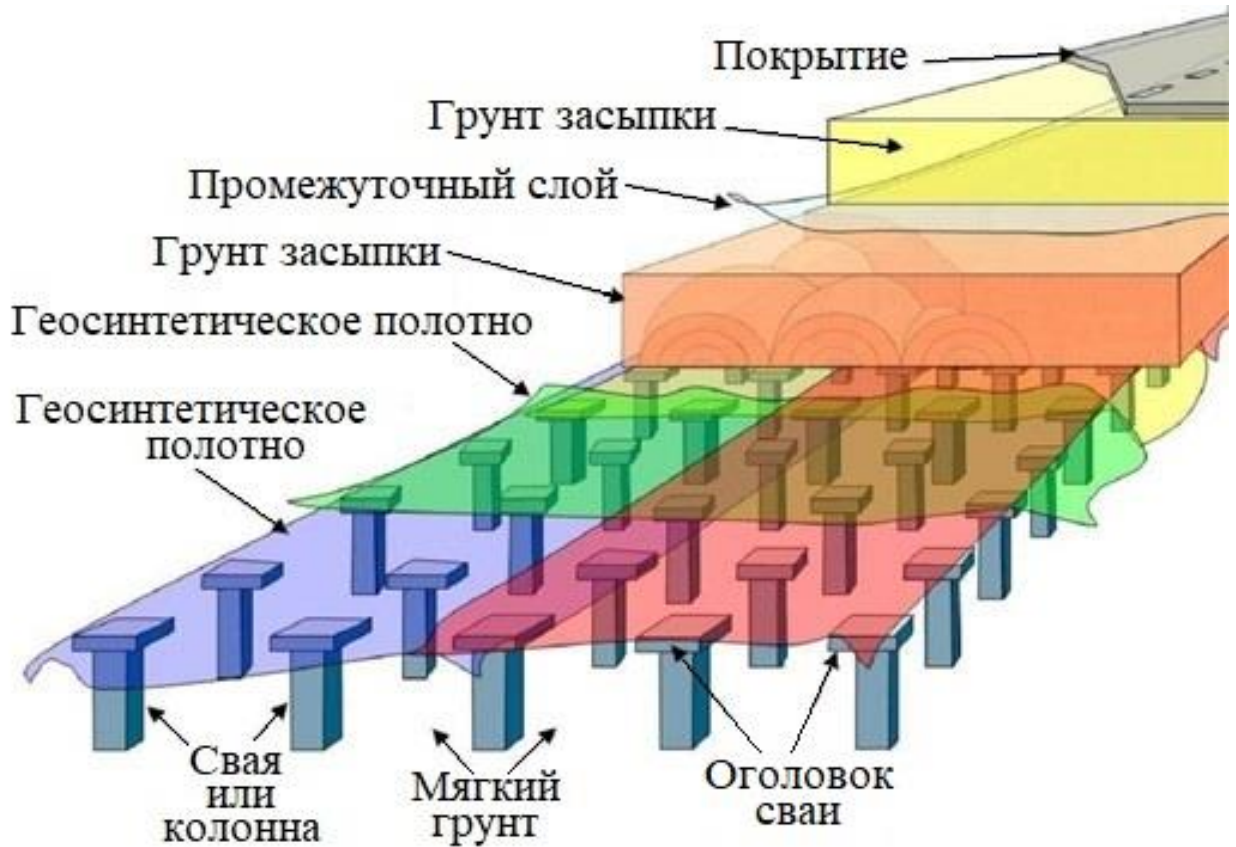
Способ обеспечения устойчивости грунтов сваями и геосинтетической арматурой
